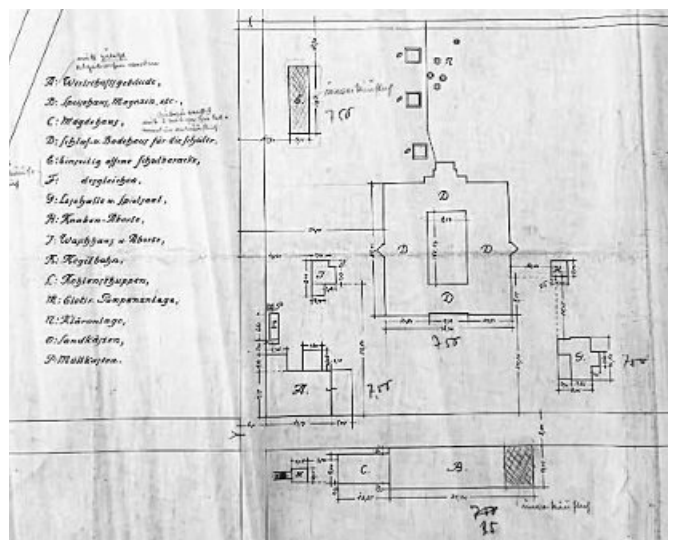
Lageplan mit Darstellung und Beschreibung der Bestandsgebäude. 1929. Ausschnitt.
